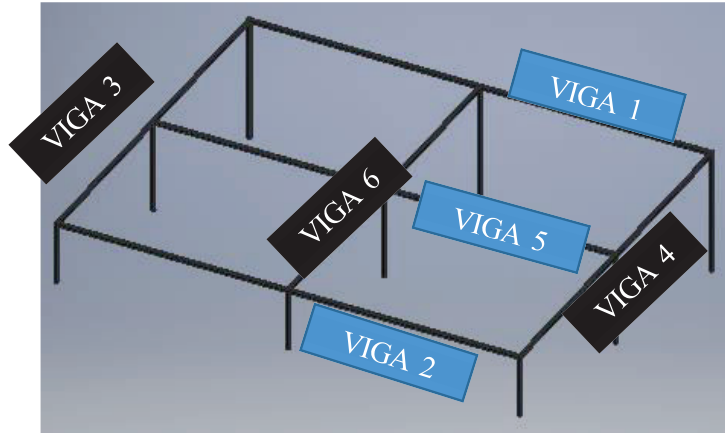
Estructura de soporte paneles fotovoltaicos
